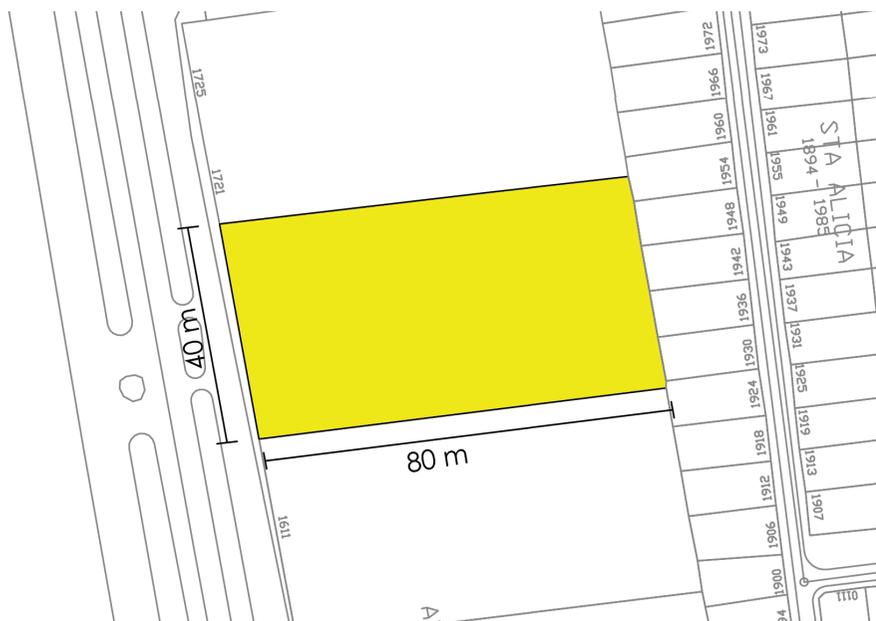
Terreno escogido. Elaboración propia en base a plano PRC Puente Alto.
